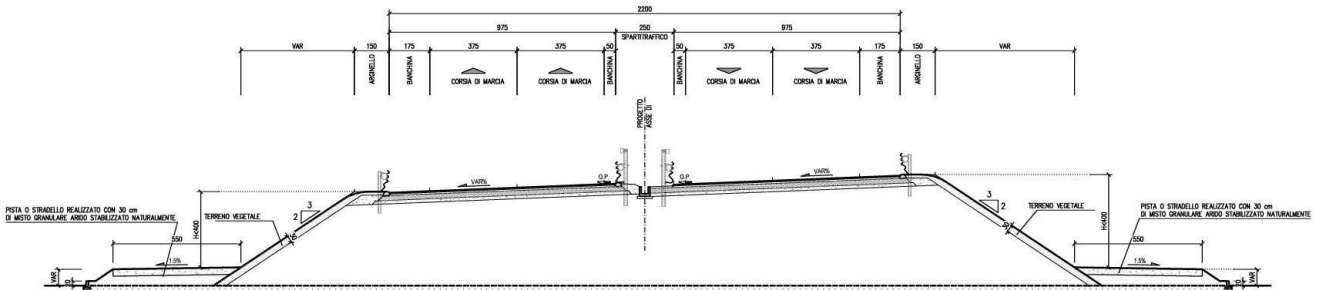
Sezione Tipo su Rilevato – Scarpata 3/2 – con stradello
